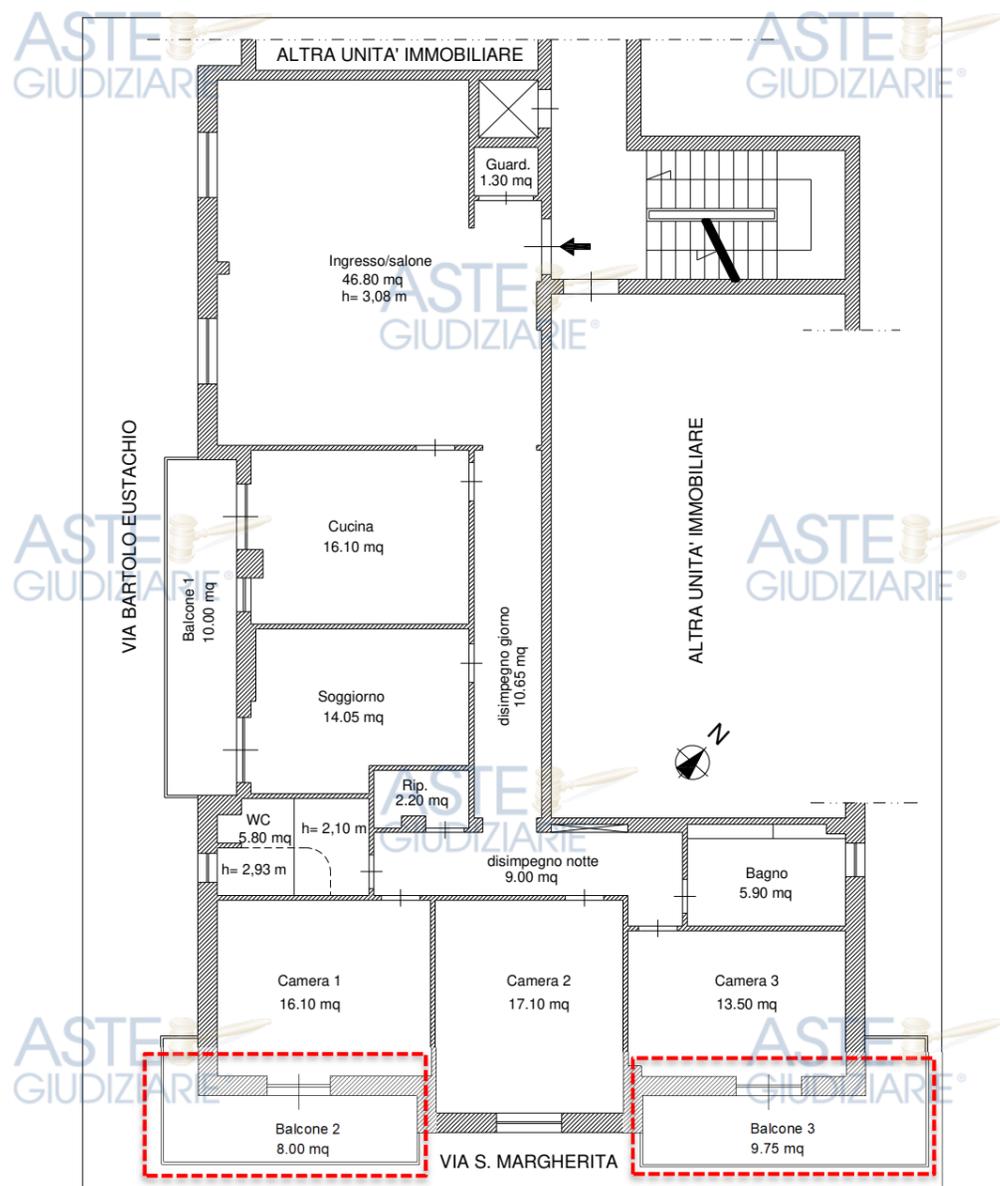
Pianta di rilievo dell'abitazione pignorata – (Lotto 3)
